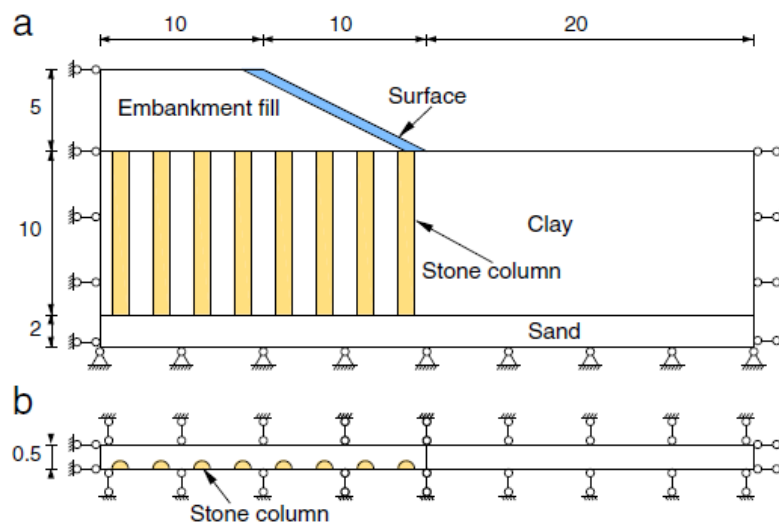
Esquema del modelo 3D (a) sección transversal; (b) planta (Unidades en m) (Zhang et al., 2013).
